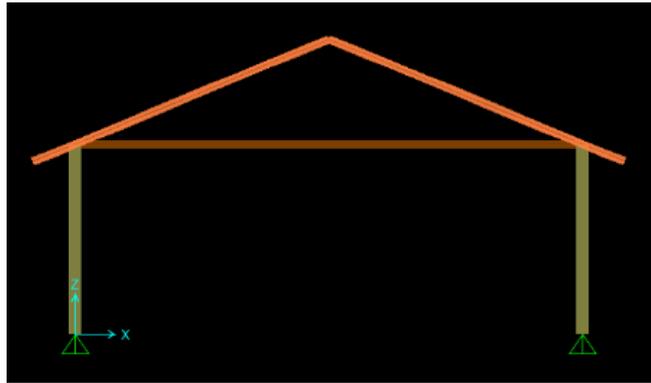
Modelado de pórtico base transversal en SAP. Fuente: Propia
